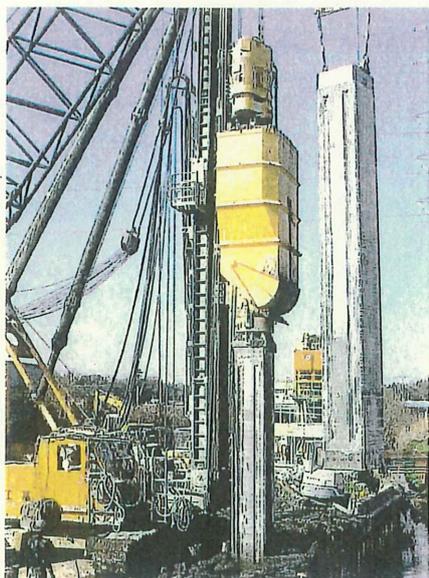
CSM工法施工機械 (クアトロサイドカッター)
